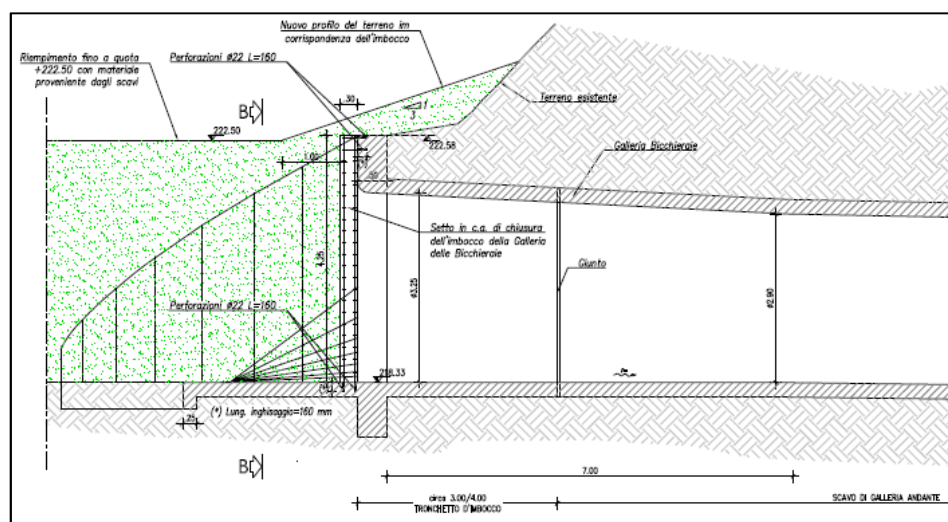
Sezione imbocco Galleria delle Bicchieraie
